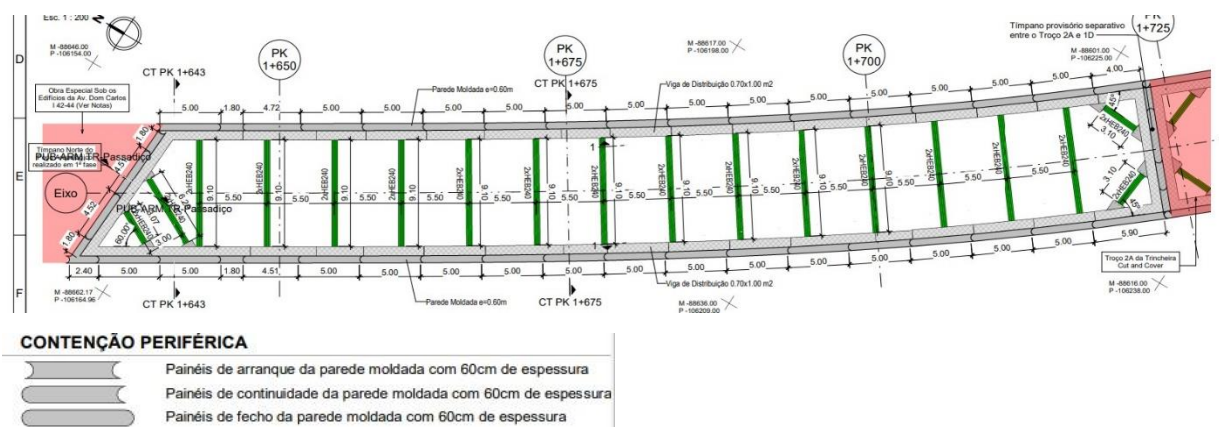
Planta troço 1A e respetiva legenda (RACS MSS PE GEO TUN T35 DW 28001 D)
